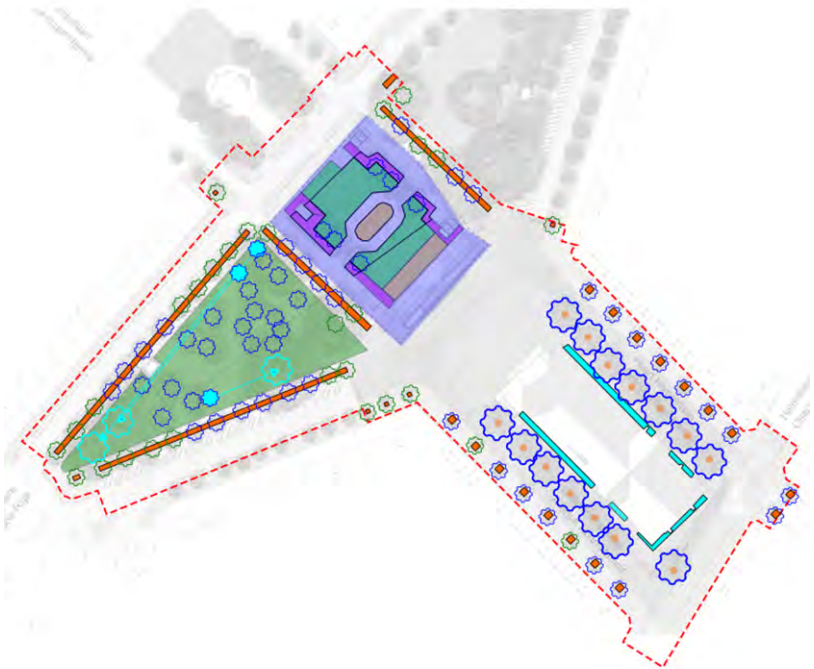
Aménagement "verts" projetés et zone considérée de construction sur dalle (ARIES, 2020 sur fond BMN 2018)
